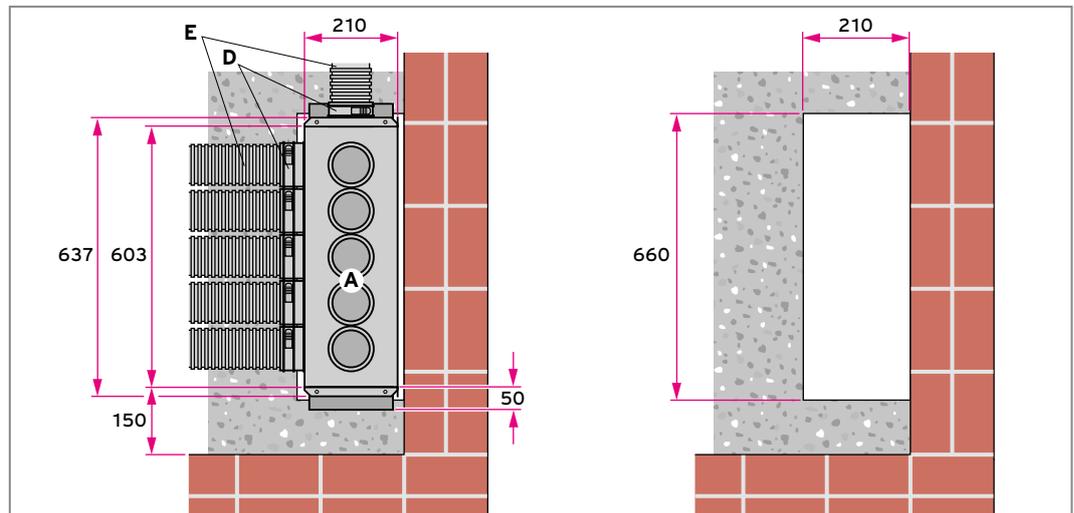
Luftverteiler/-sammler für runde Luftschläuche in der Rohbetondecke, Draufsicht
